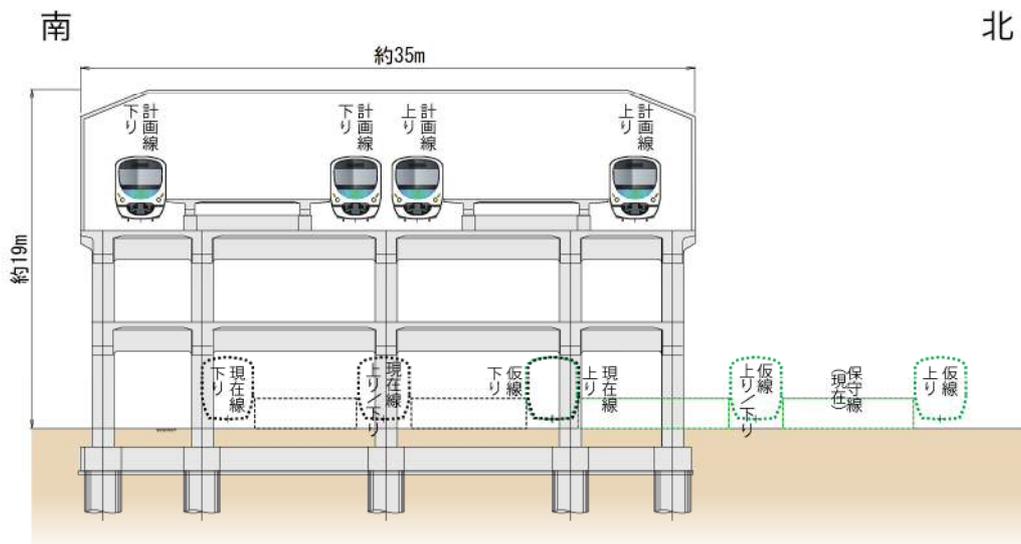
(2) 駅部標準断面図 (D-D' 断面：上石神井駅)
